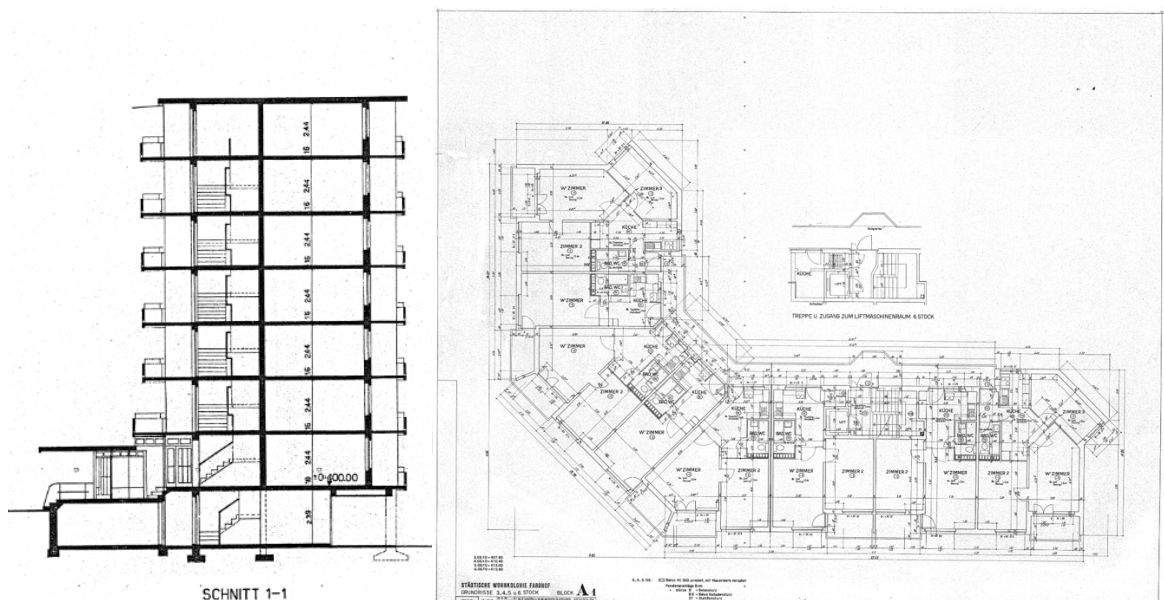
Schnitt und Grundriss eines der fünf Baukörper des Farbhofs, Quelle: Stadt Zürich, AHB.
